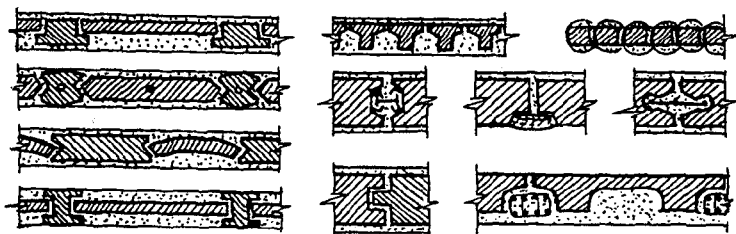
Конструкции траншейных стен в сборном варианте и стыков между сборными железобетонными панелями
